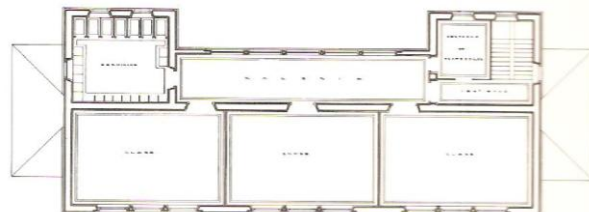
Planta primera. “Aurelio Gómez Millán: Arquitectos”.
